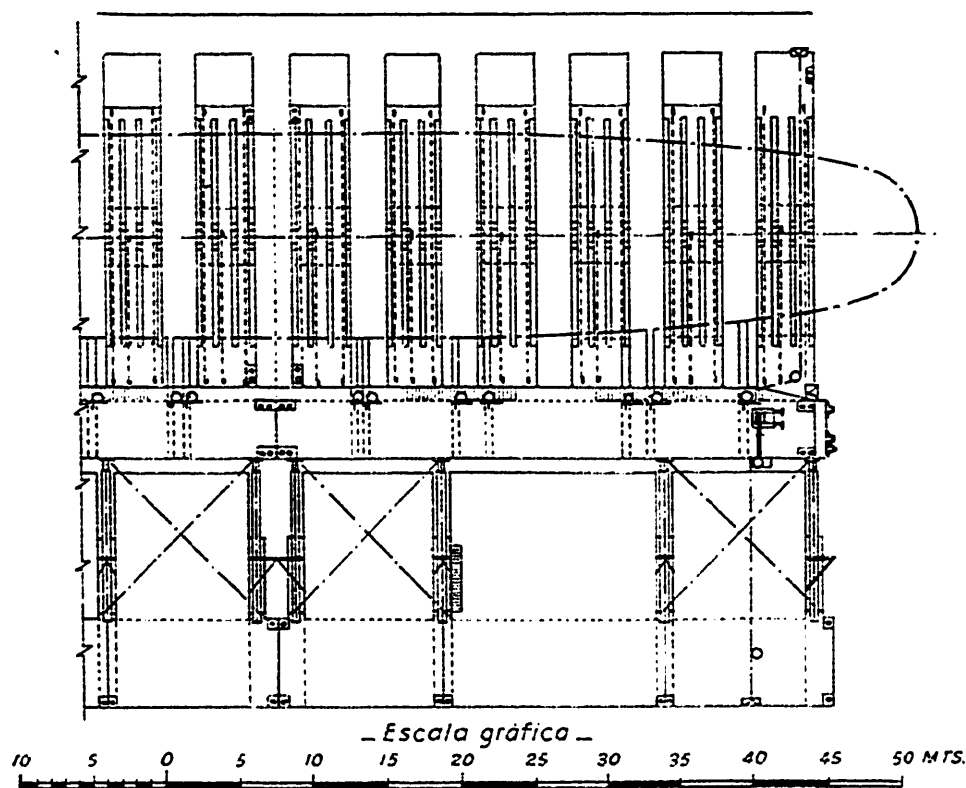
ª — Planta parcial del dique flotante y deponente del puerto de Barcelona.
